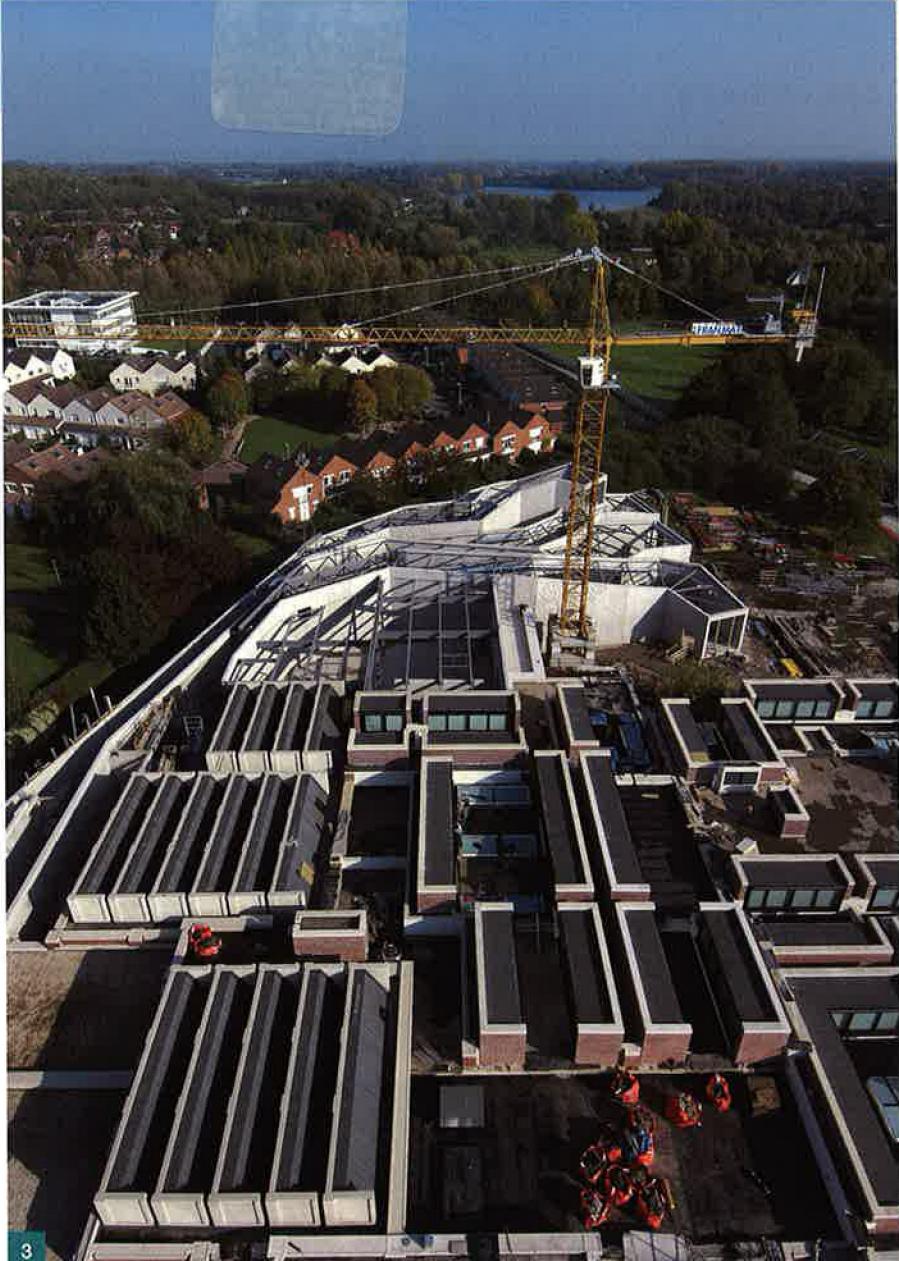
Střechy původního objektu se staveništěm nového rozšíření muzea ■ Fig. 3 Roofs of the existing building with the building site of the new extension
